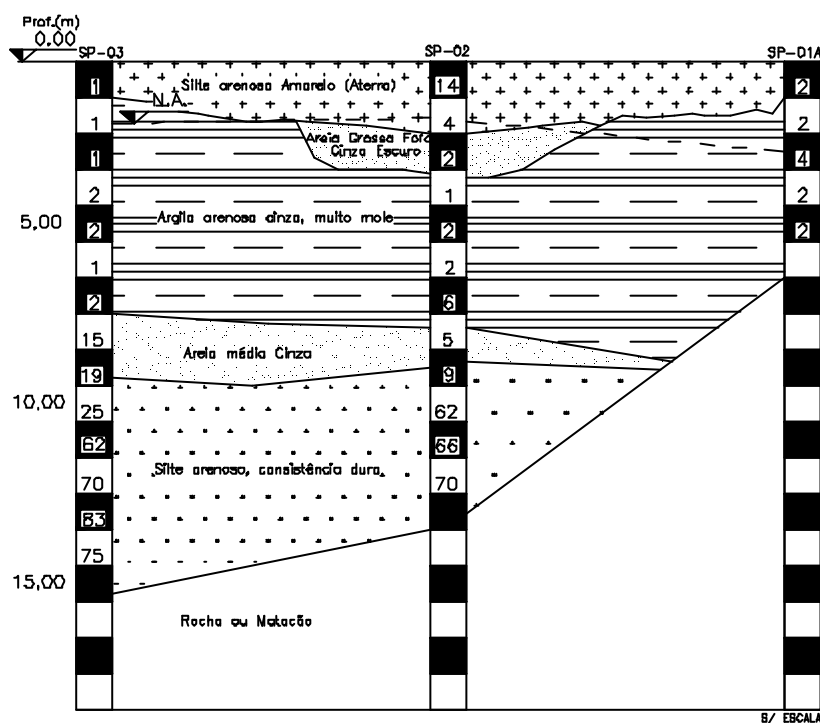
Perfil de Sondagem à Percussão, corte 1-2.
